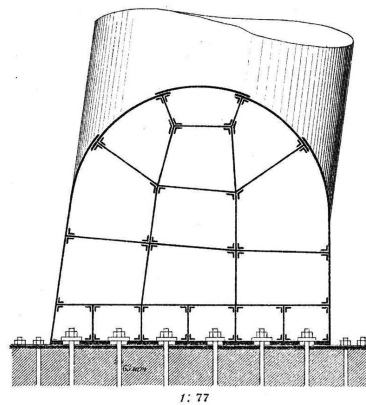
Auflagerdetail der Firth of Forth Bridge mit innerer Versteifung, 1890
